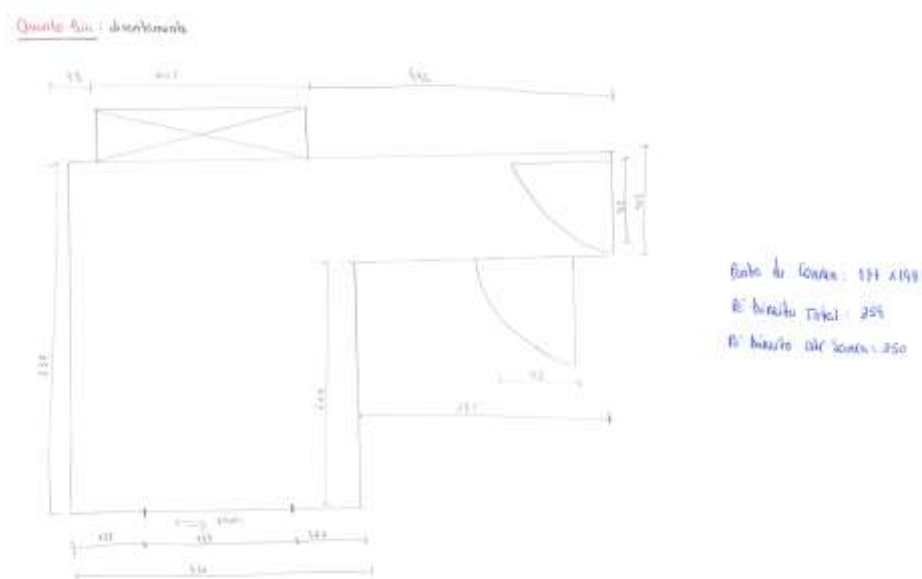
Levantamento das dimensões do quarto – Planta à mão levantada
